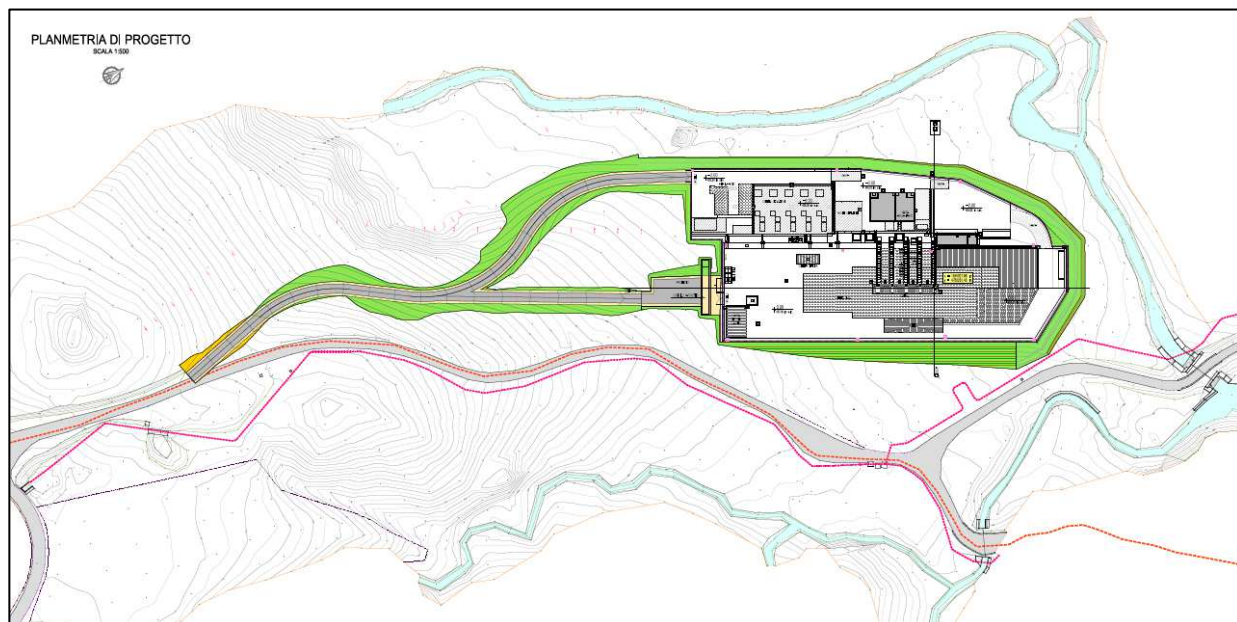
Planimetria con indicate le opere (per il dettaglio vedere Tav. GRE.EEC.D.28.IT.G.13405.00.033 – PROGETTO DEFINITIVO POSTAZIONE: Planimetria Stato di Progetto). In verde i rilevati di sostegno.
